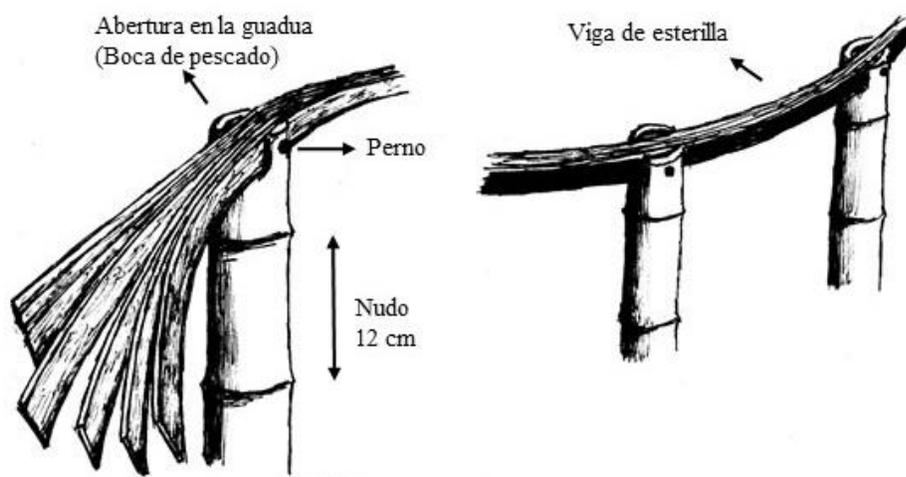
Detalle de ensamblaje entre columna y viga de esterilla.
